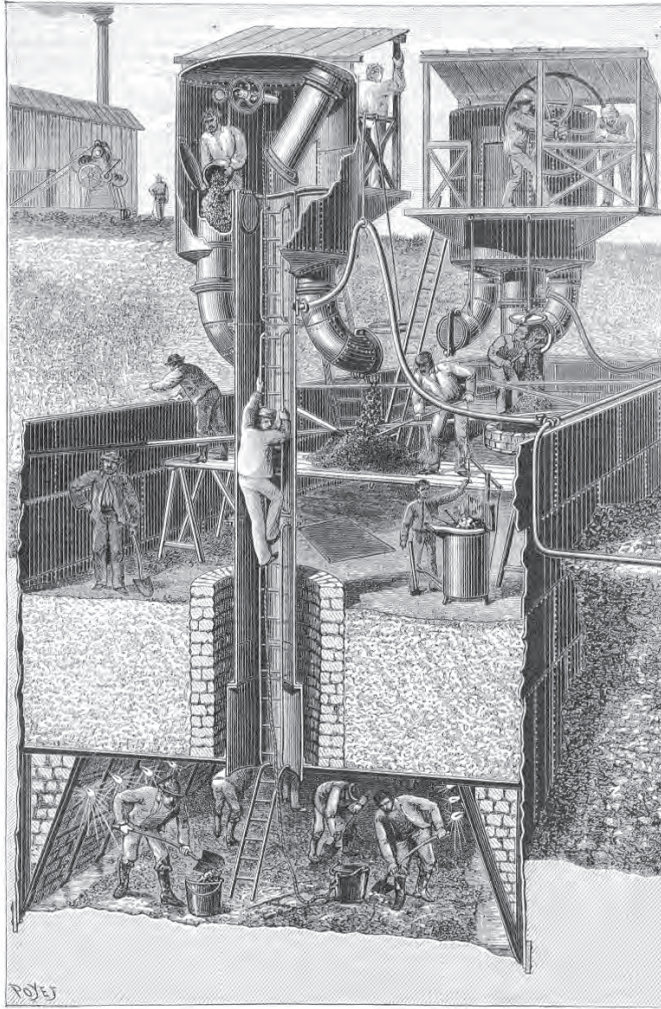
« Vue d'un caisson pour la fondation de la tour Eiffel par l'air comprimé. Coupe montrant le travail souterrain et les tubes d'accès et de déblaiement », dessin de Louis Poyet
